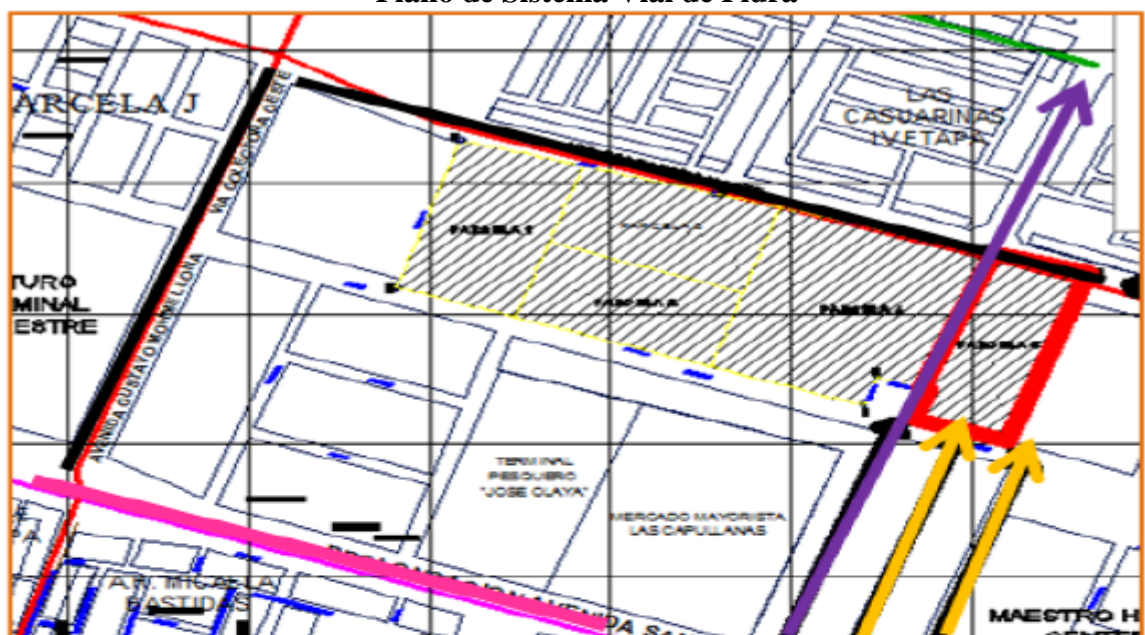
PLANO DE SISTEMA VIAL DE PIURA
